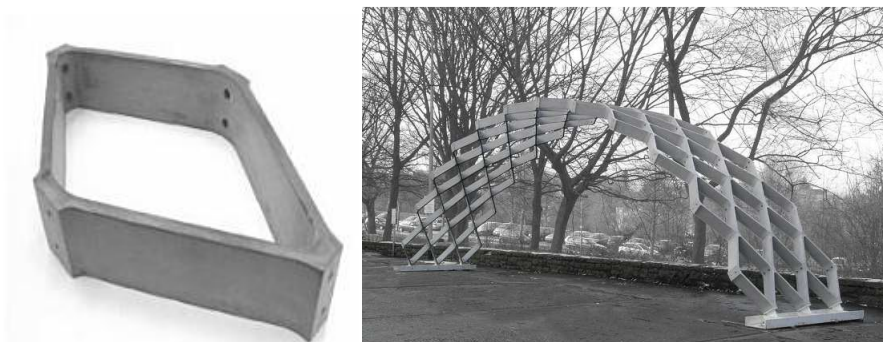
Elemento singolo a losanga in TRC e sua applicazione nella copertura reticolare
